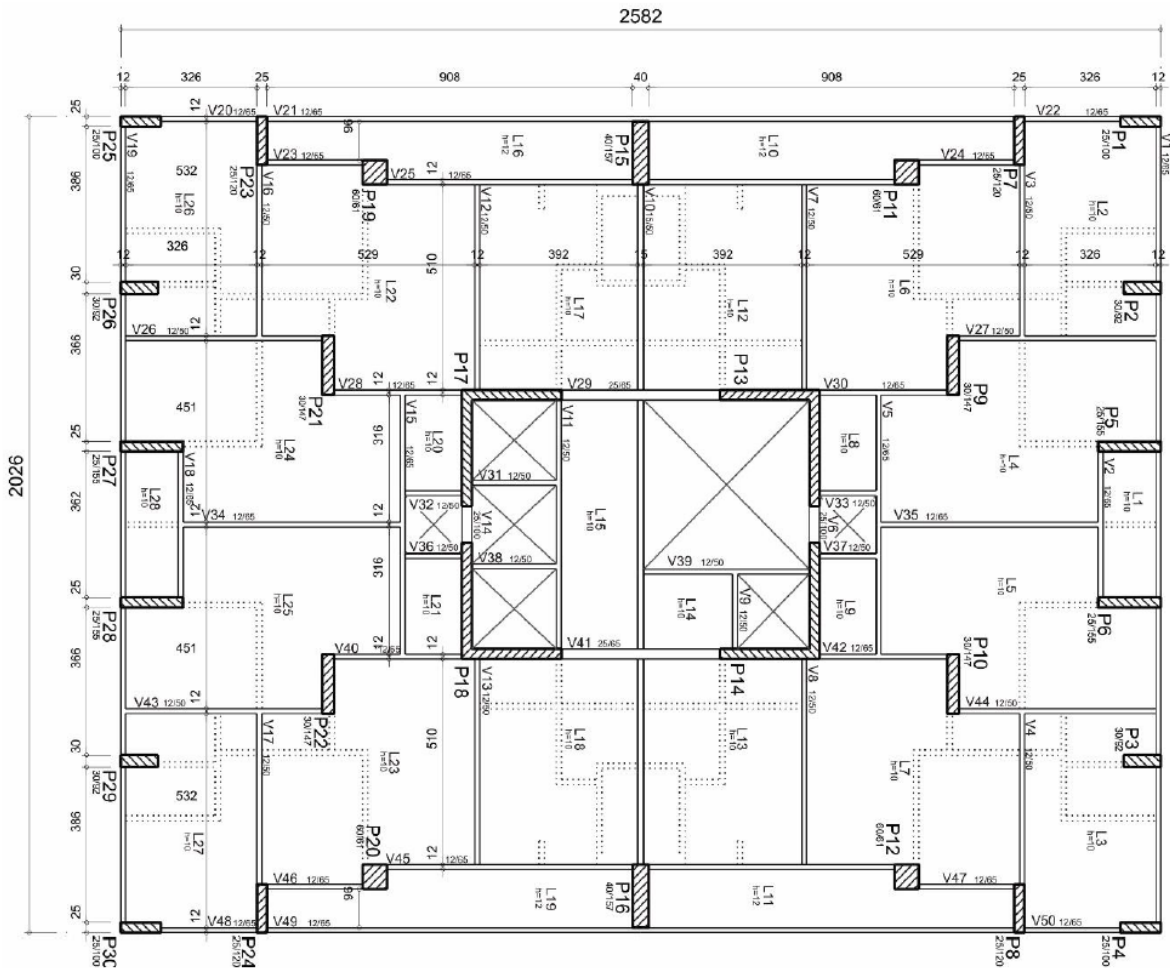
Planta do projeto estrutural para os pavimentos tipo (dimensões em centímetros).
